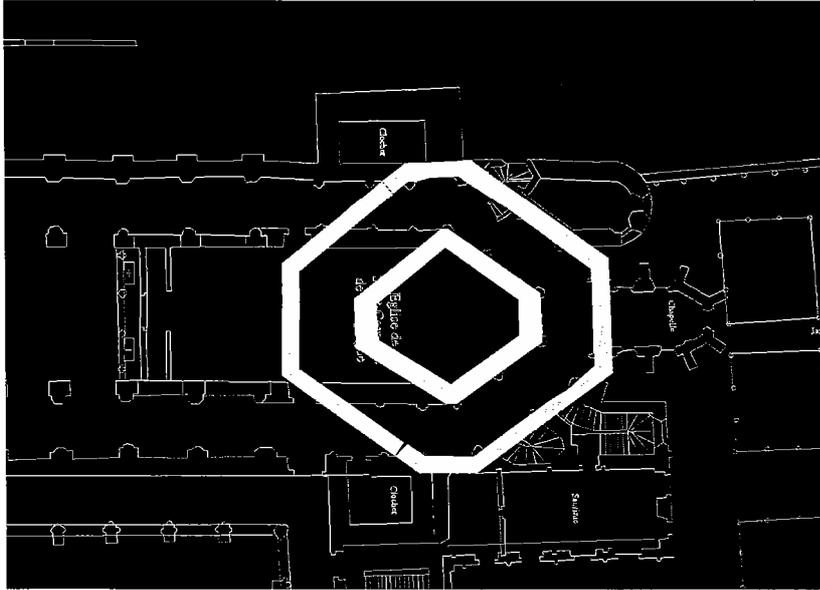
essai de construction d'une rotonde sur le chœur polygonal de Saint-Corneille. Plan.
